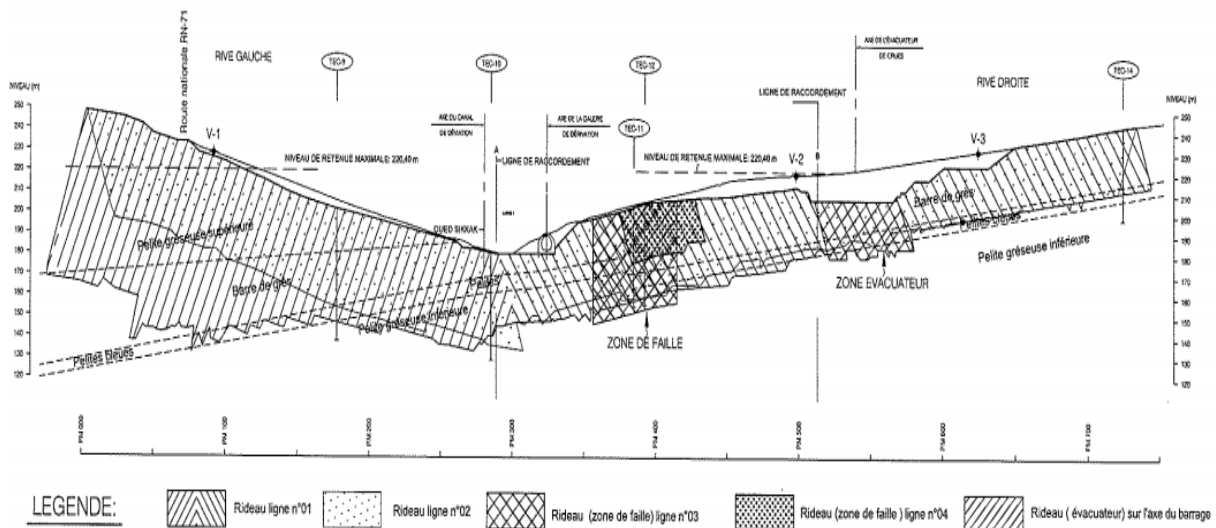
Coupe longitudinale - Rideau d'injection
